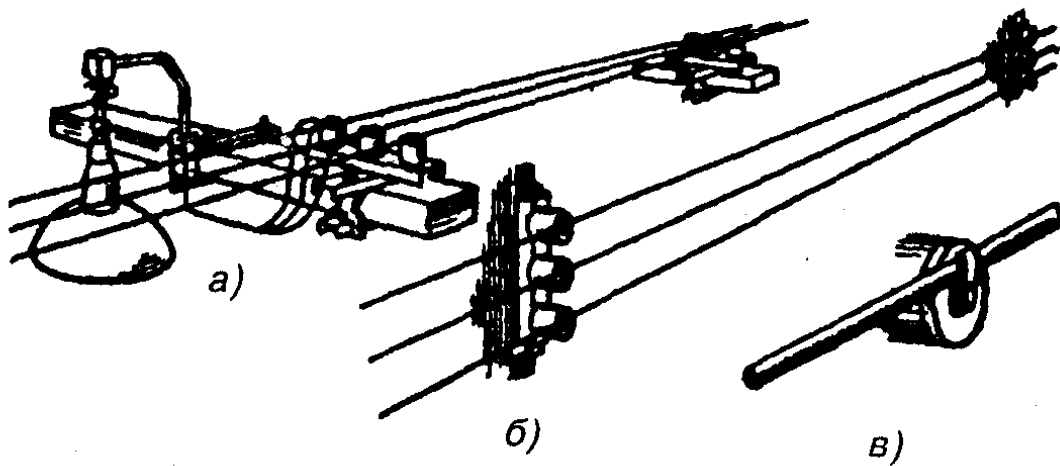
Примеры выполнения электропроводки на изоляторах:
